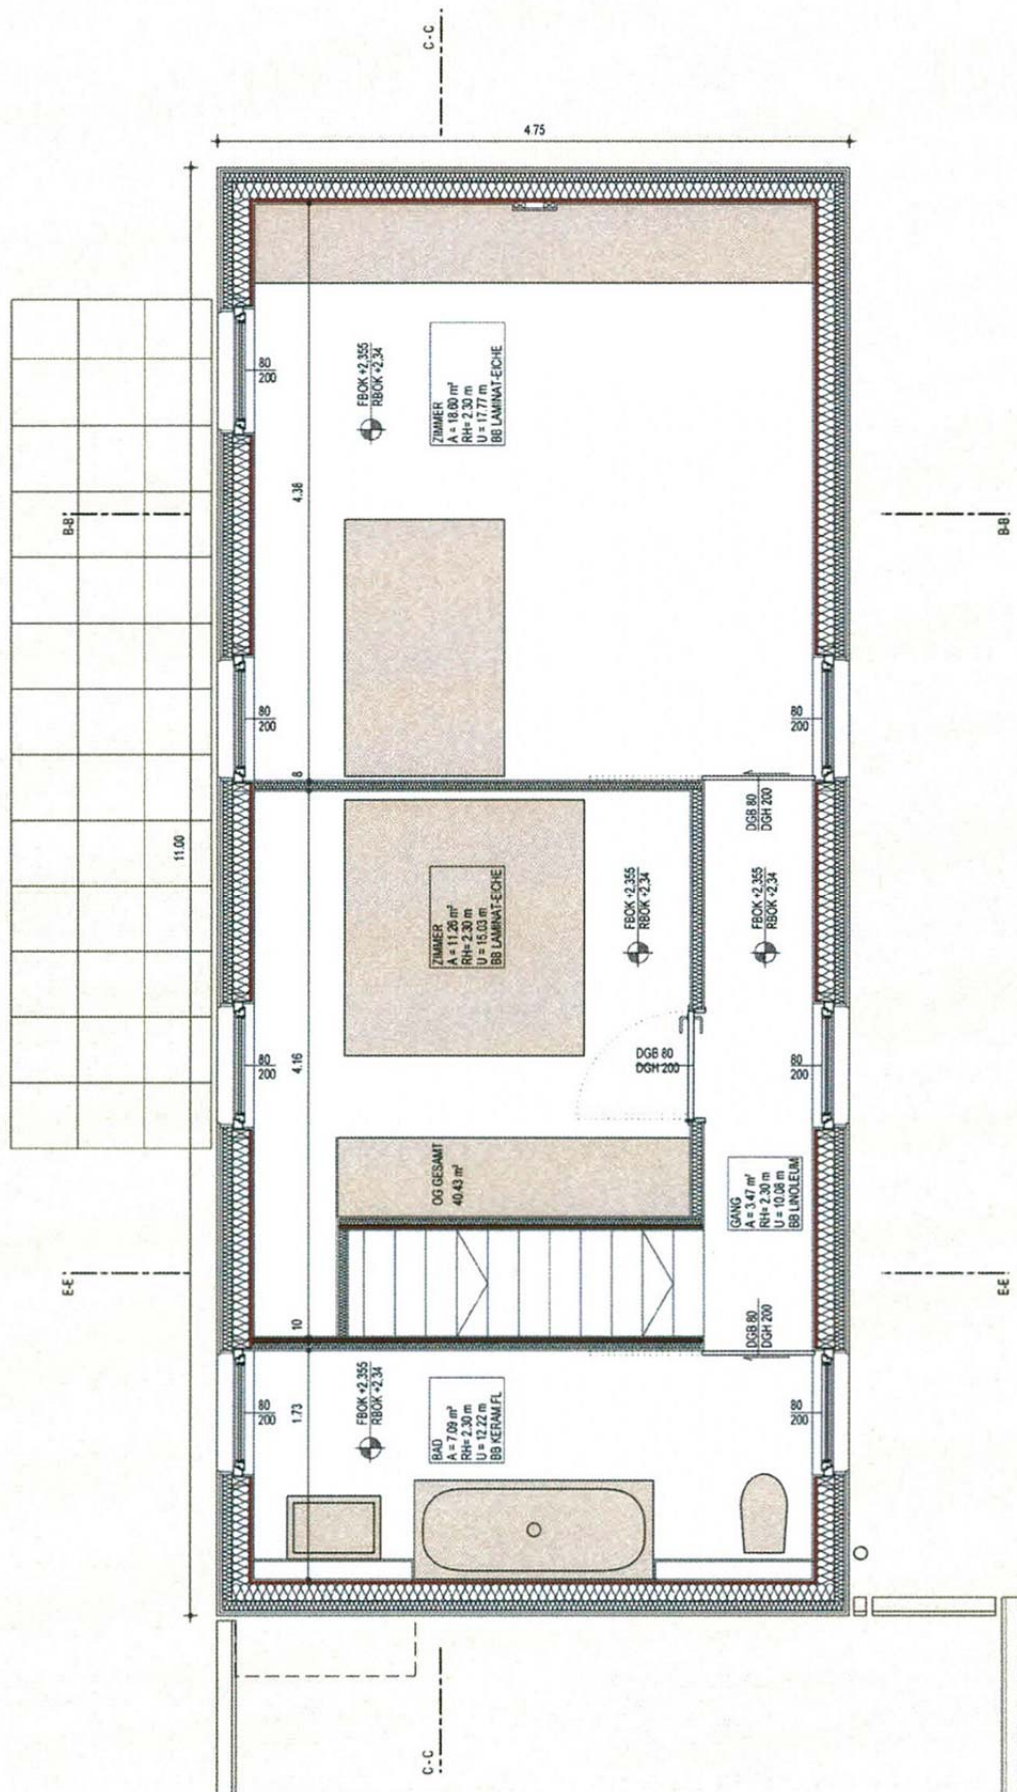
Grundriss Obergeschoss _ Typ A ohne Keller
